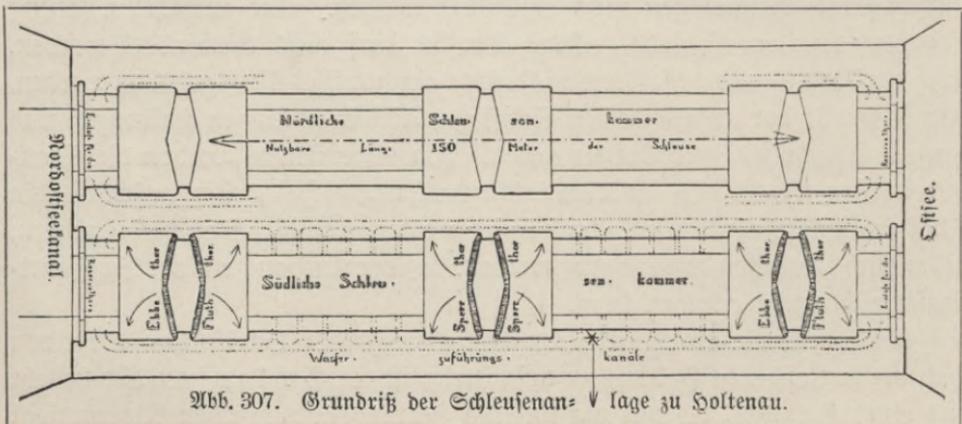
Grundriß der Schleusenanz- lage zu Holtenuau.
